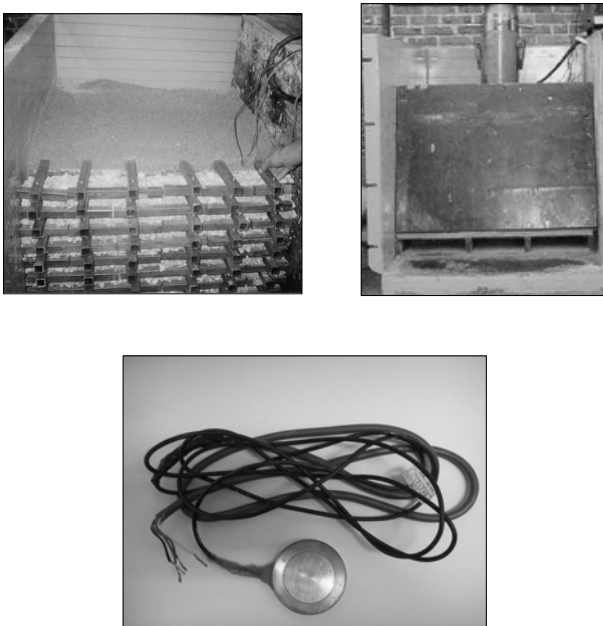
Crib wall과 일체식 옹벽의 설치전경과 사용된 토압계
